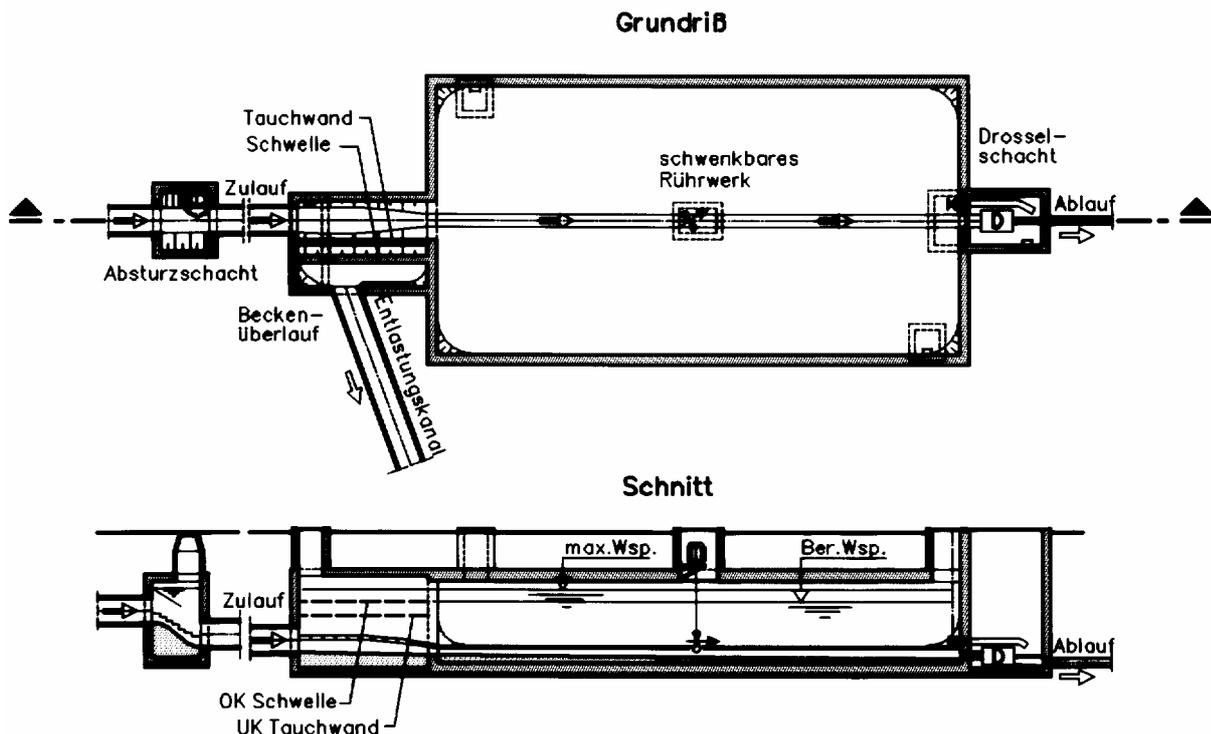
Systemzeichnung eines Rechteckbeckens (Fangbecken) im Hauptschluß mit schwenkbarem Rührwerk
